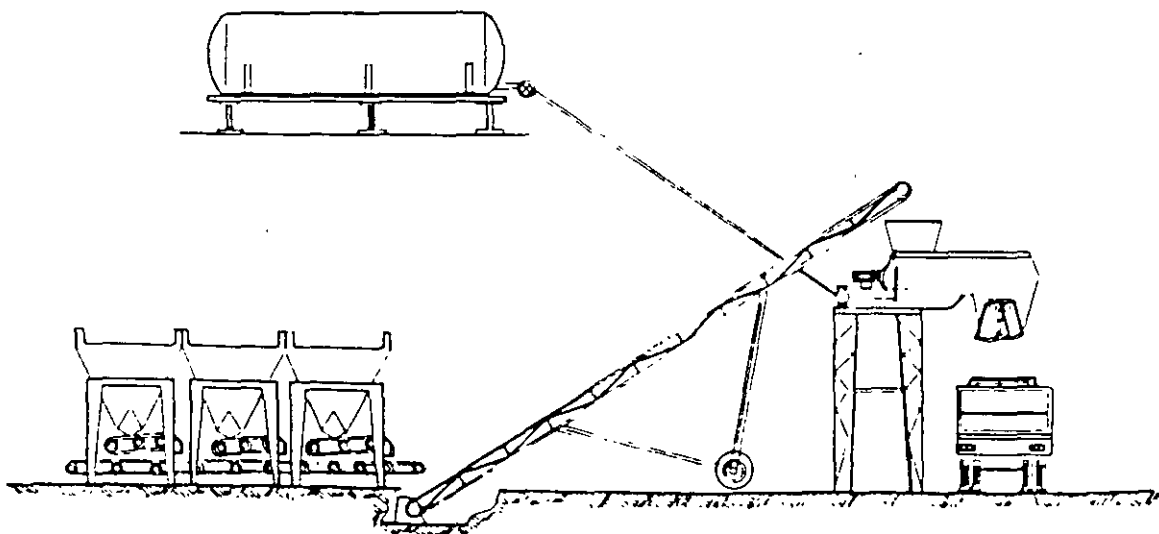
Esquema de una planta de fabricación de M.A.F.
